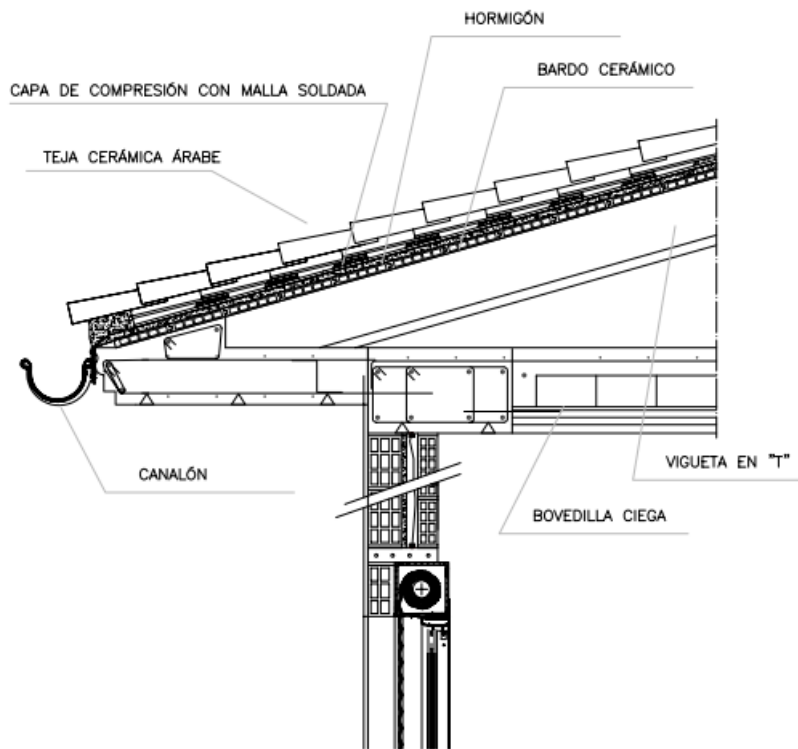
Detalle encuentro original cubierta. Año 2015. Fuente propia.
